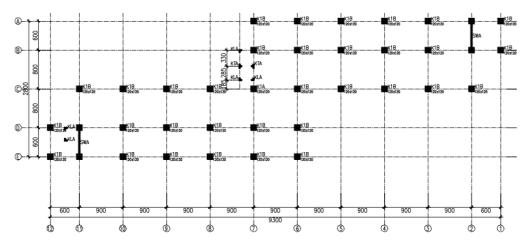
Tipikal Denah Lantai 2 s.d 12 Sumber: DED Proyek
